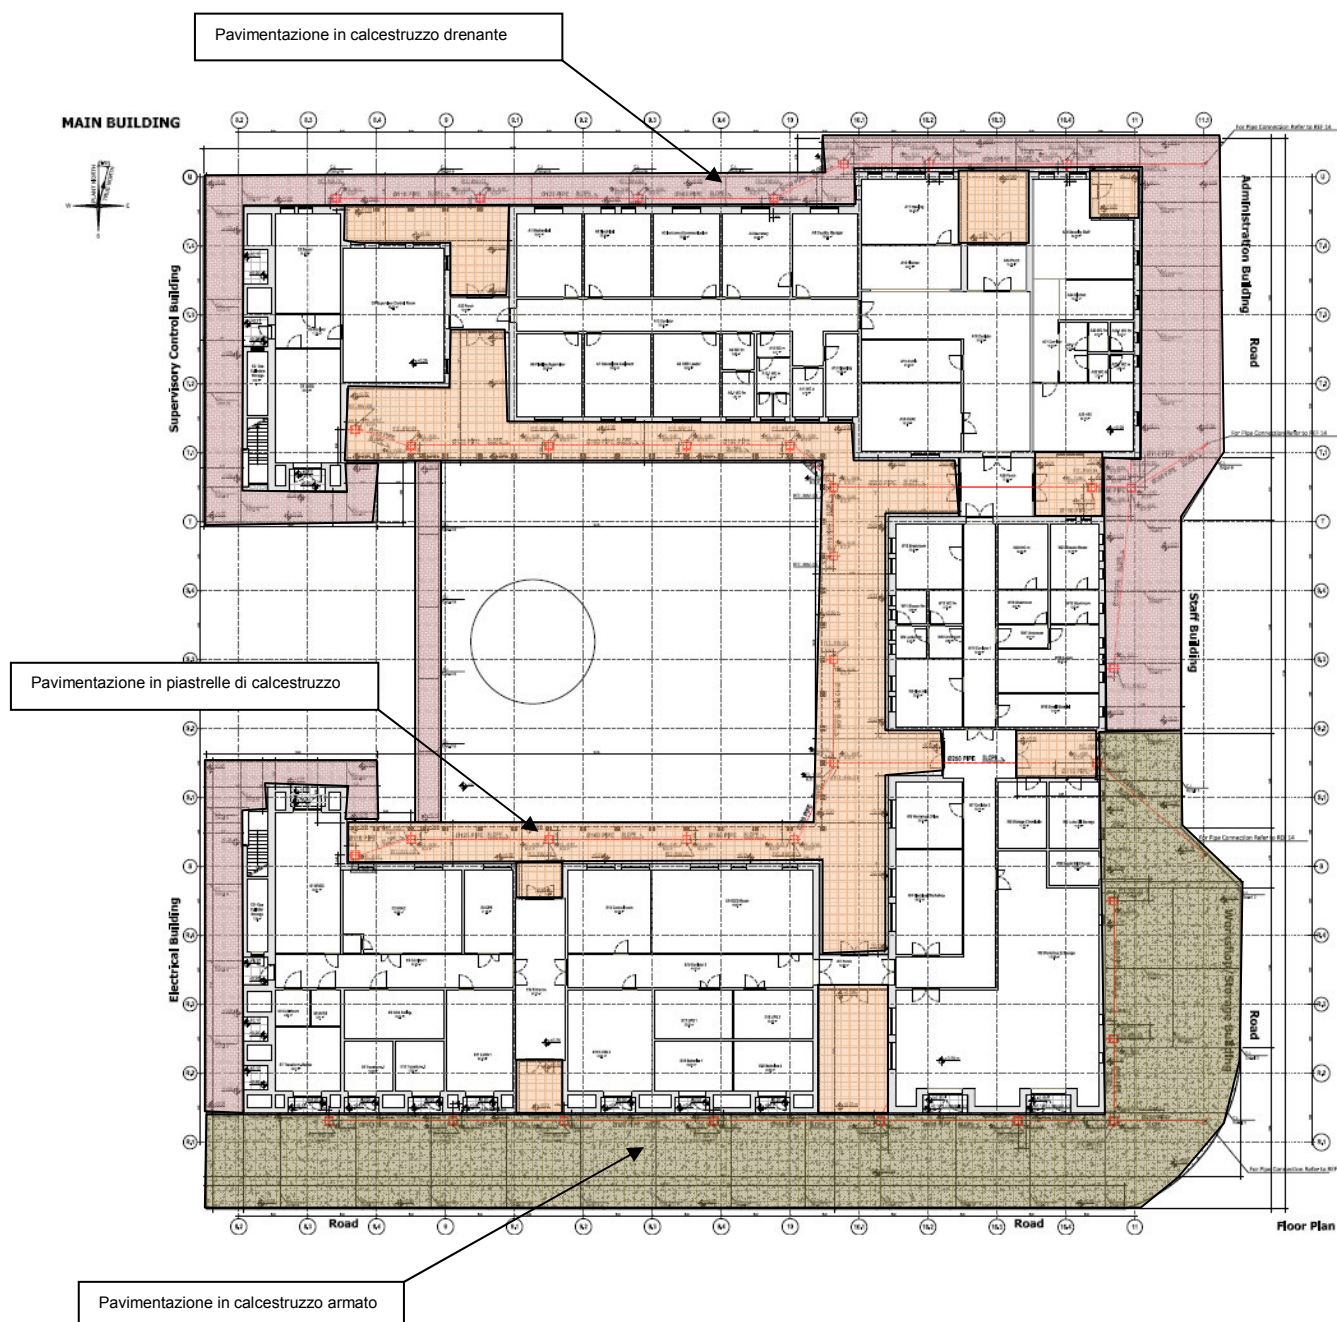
Edificio Principale – Planimetria Pavimentazioni Esterne
